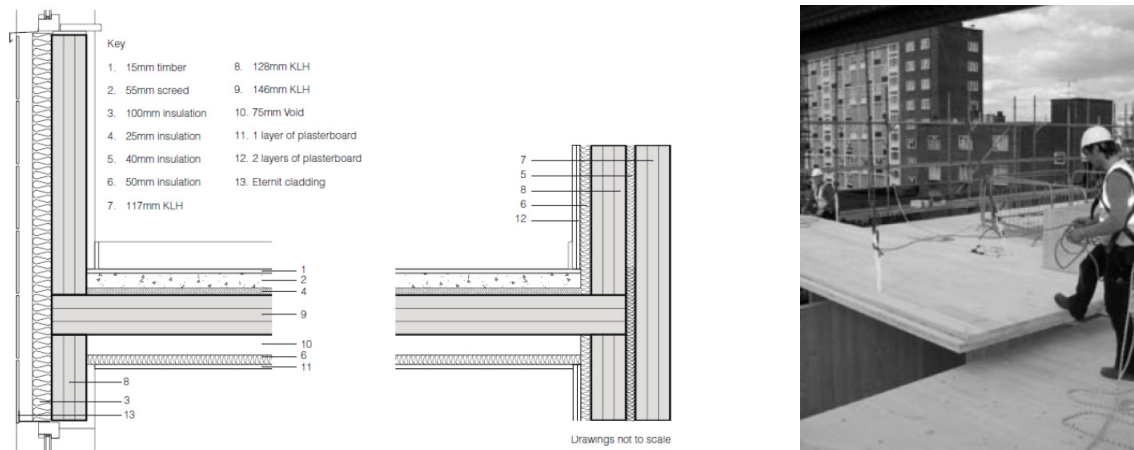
Izquierda a derecha: detalle de fachada, detalle de separación con el núcleo, construcción del edificio mediante paneles CLT. TRADA technology, www.trada.co.uk y Waugh Thistleton Architects.
